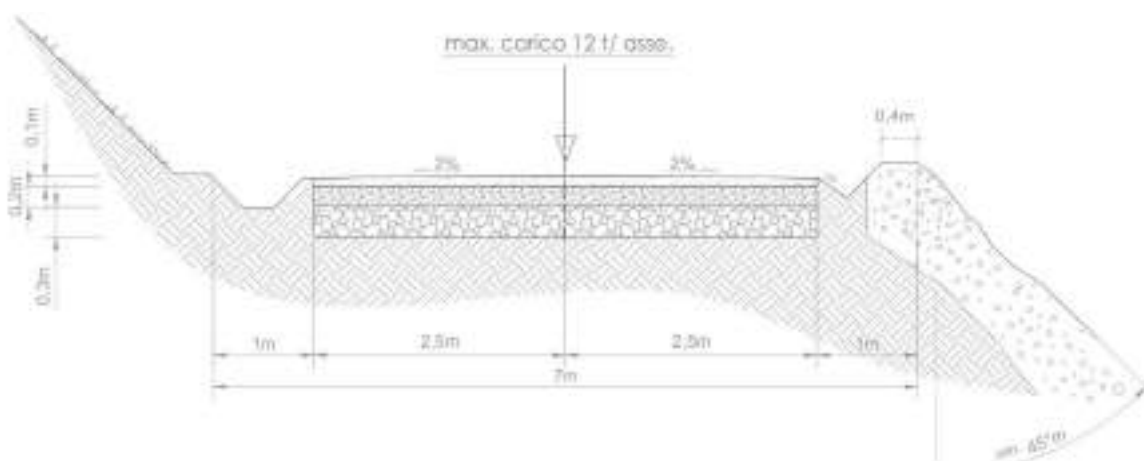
Sezione stradale tipo con scarpata (mezza costa)
